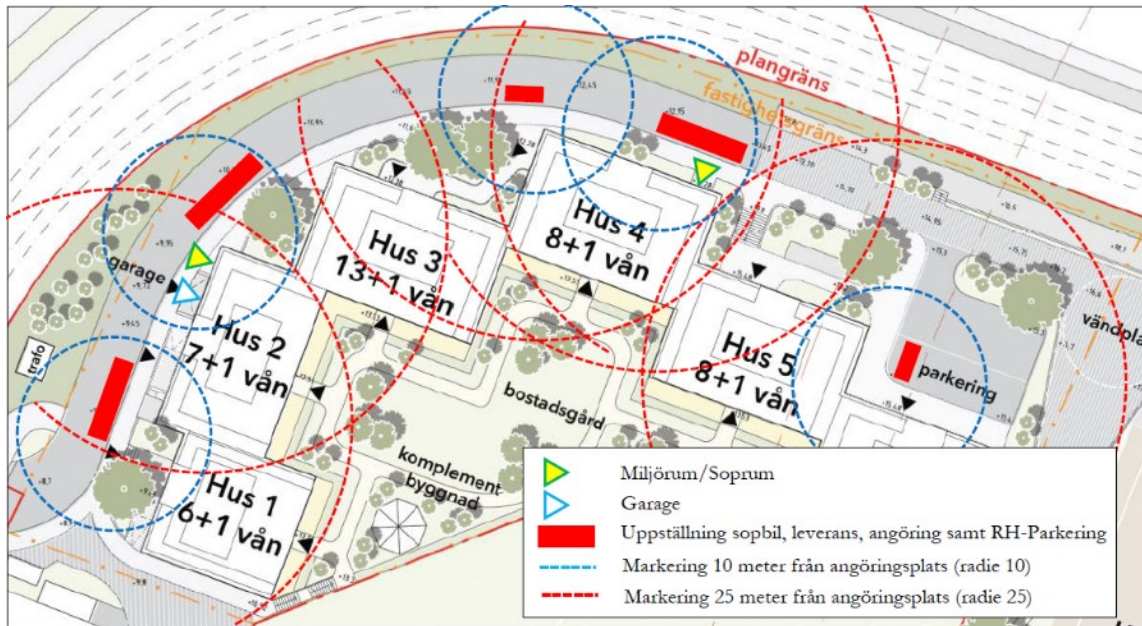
Planerad sophantering, östra delen av planområdet. (Structor, 2025)
